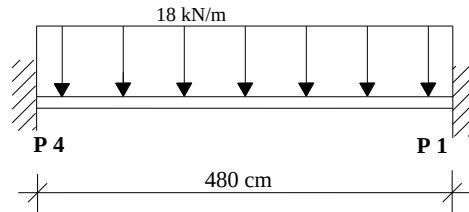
Esquema estático e carregamento no vão da viga adjacente ao pilar P1.
